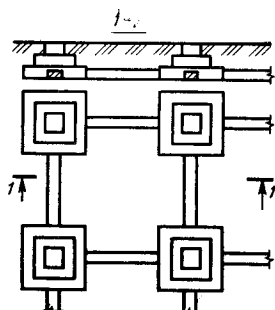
Устройство отдельных фундаментов со связевыми вставками
